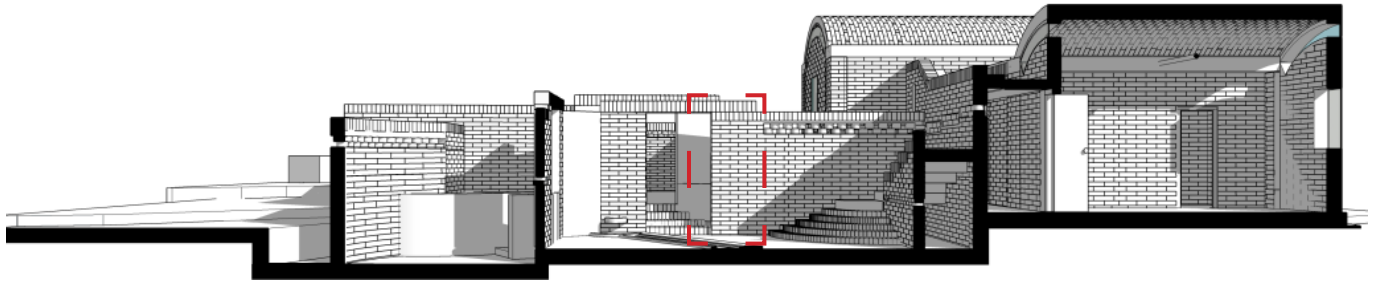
Sección axonométrica de referencia detalle constructivo 2'.
